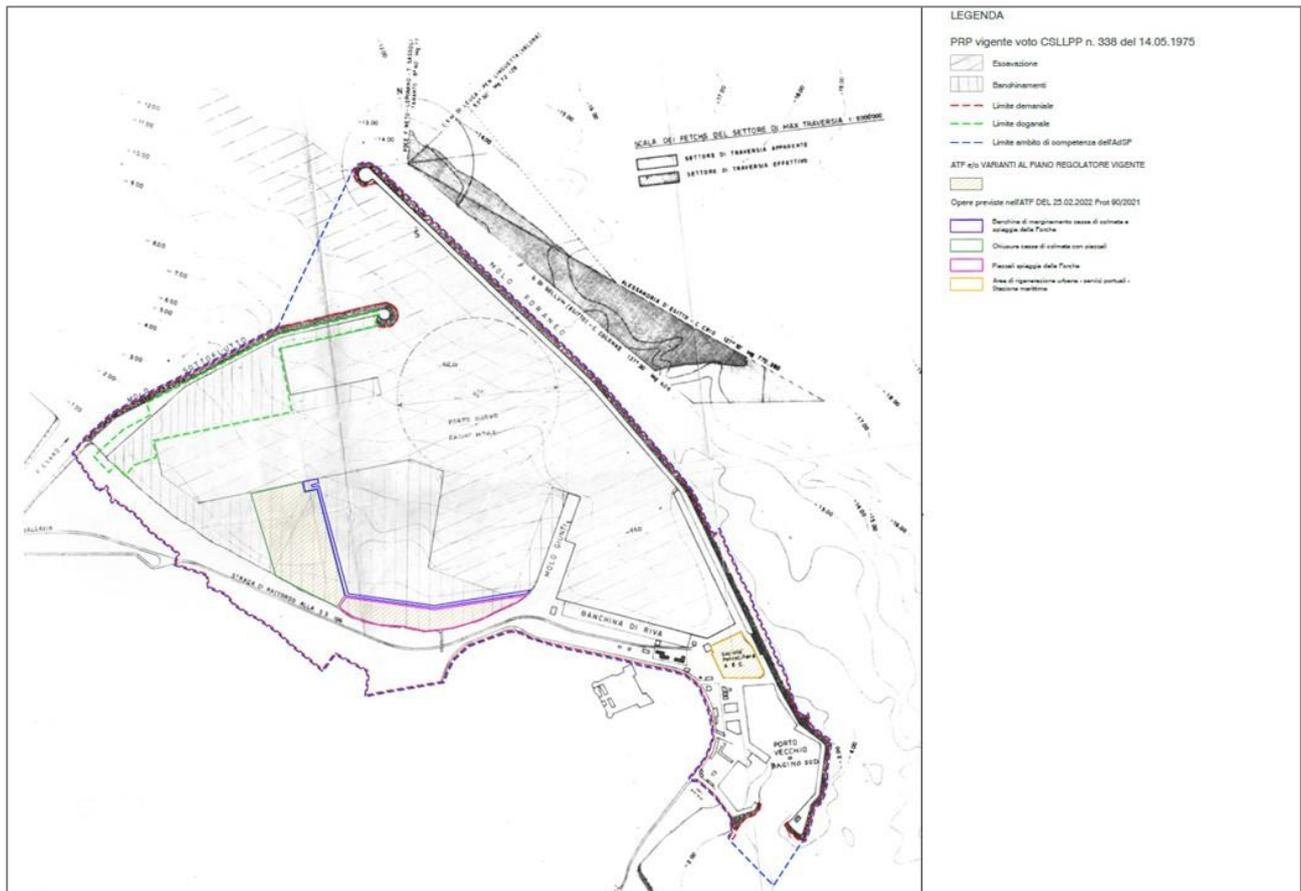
Piano Regolatore Portuale vigente del Porto di Crotona.
